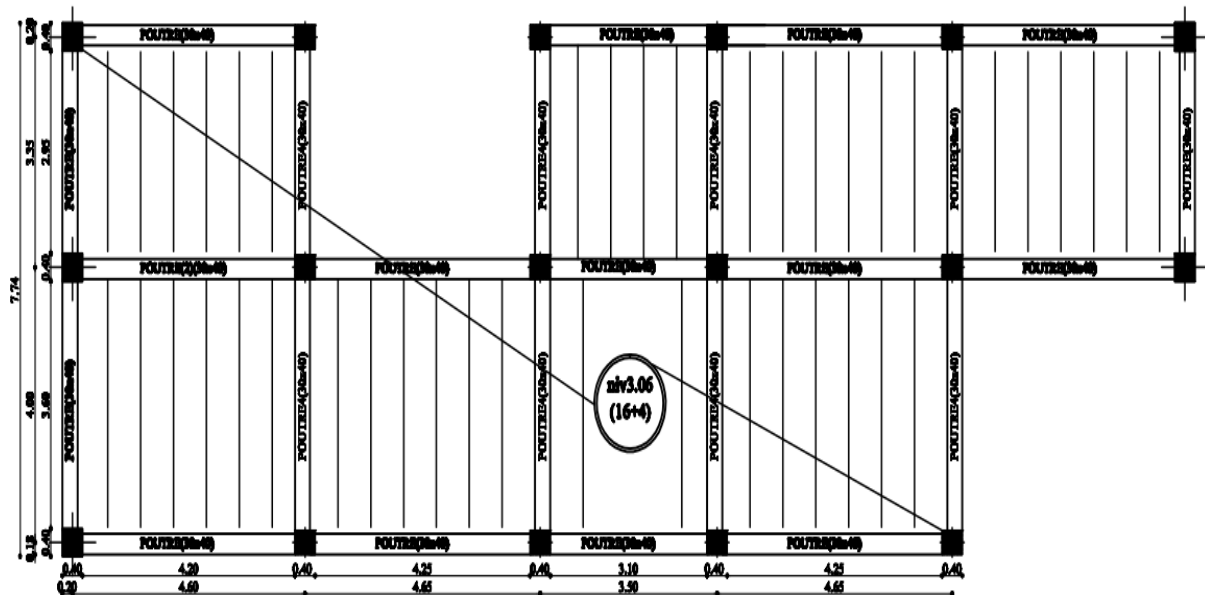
Vue en plan d'un étage courant structure (Irrégulière).
